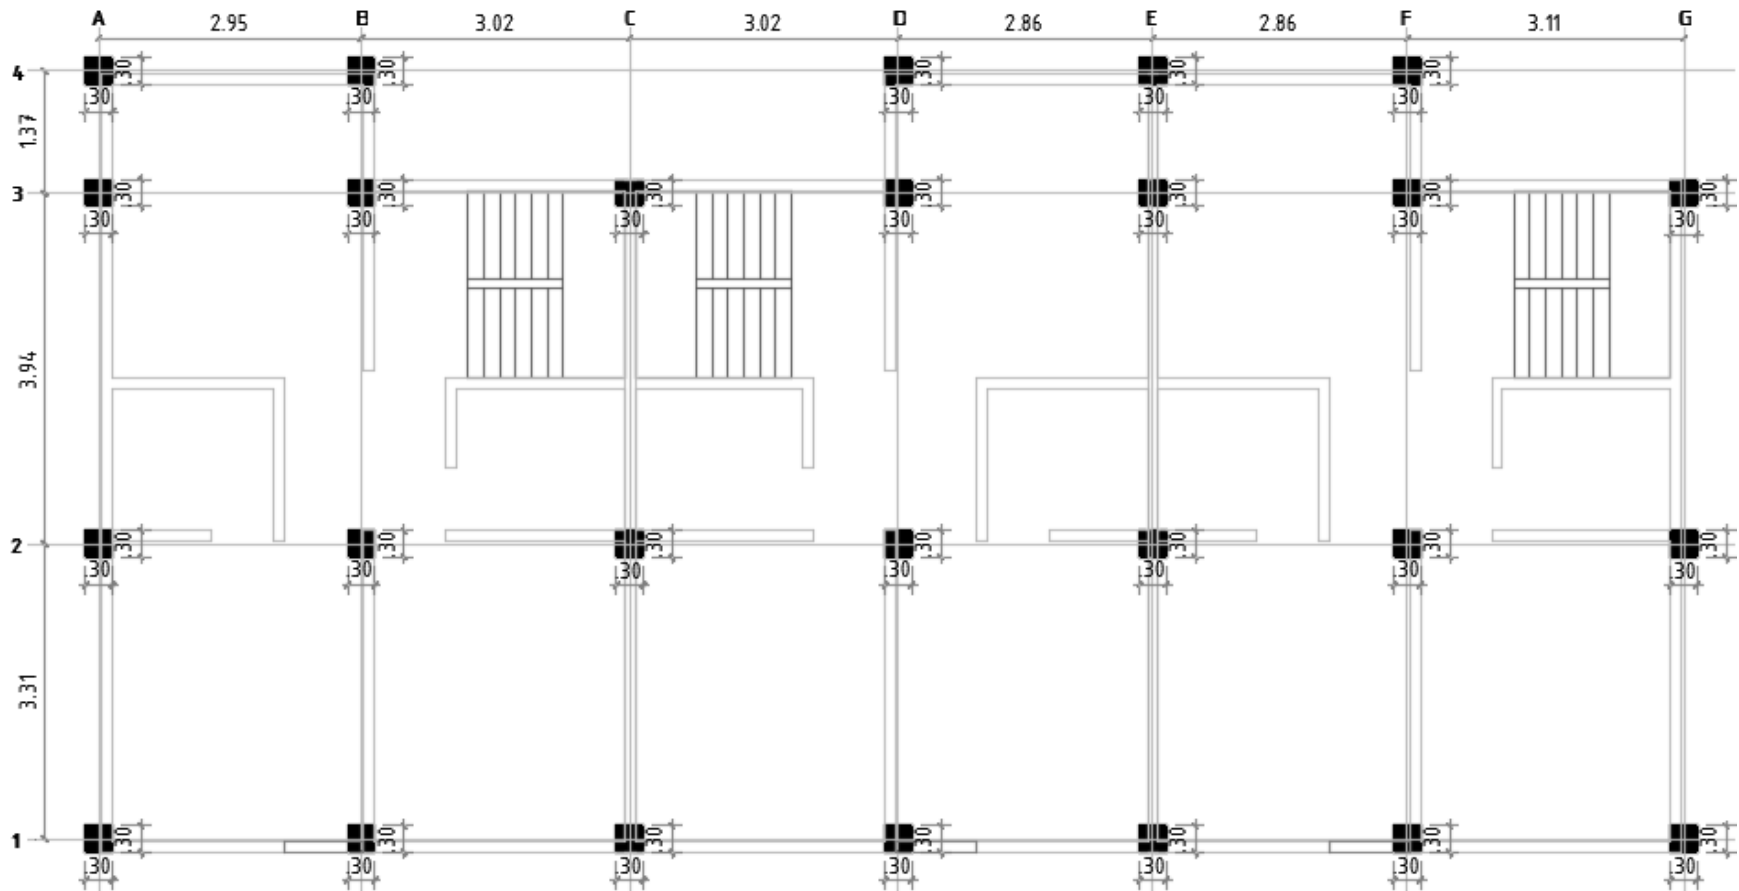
Replanteo de pórticos de viviendas de dos pisos (planta nivel 2)
